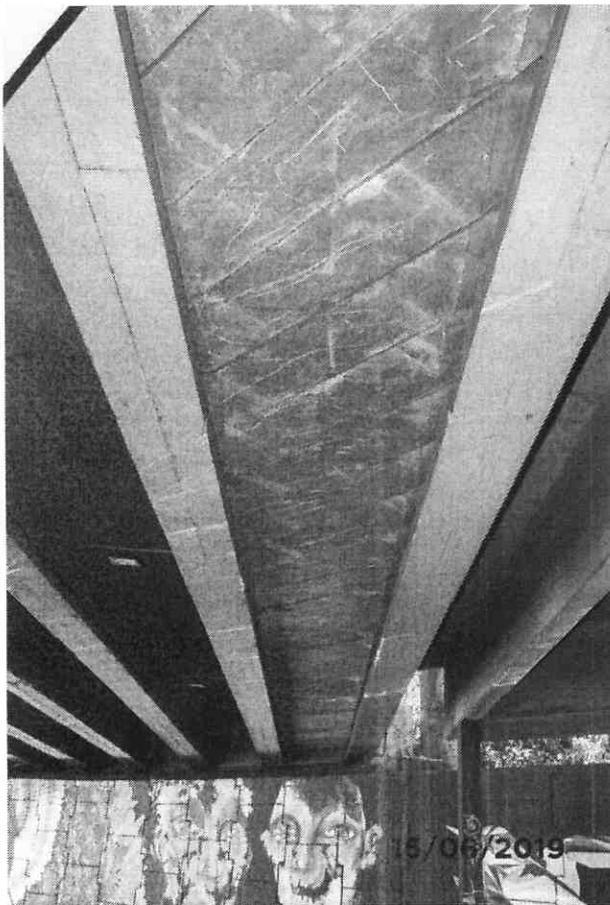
Vista da face inferior do tabuleiro, sentido centro. Vigas com deslocamento de concreto, infiltrações, armaduras expostas.
